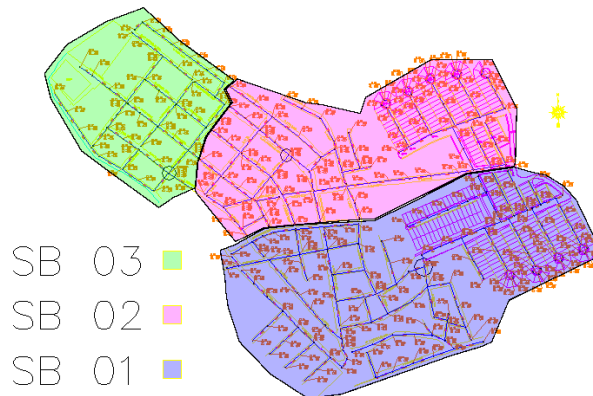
Divisão das sub-bacias das redes coletoras de esgoto. Fonte: Planta Autocad
